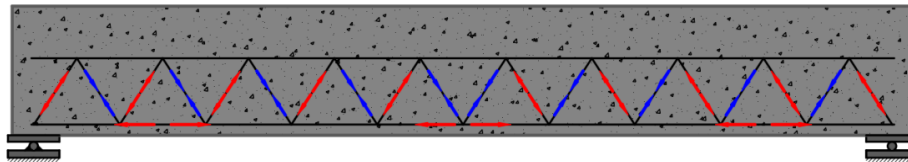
Схема перераспределения усилий на продольные составляющие в поперечных стержнях
